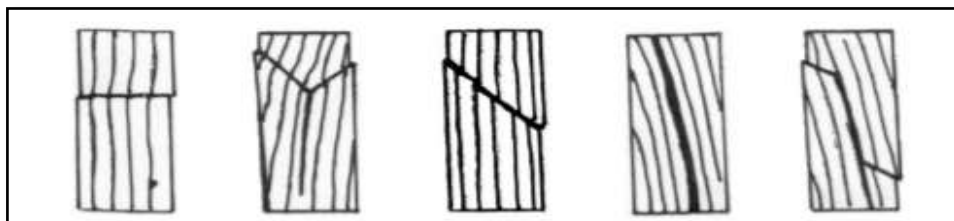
Tipo de falla para probetas de plástico reciclado en Tracción
